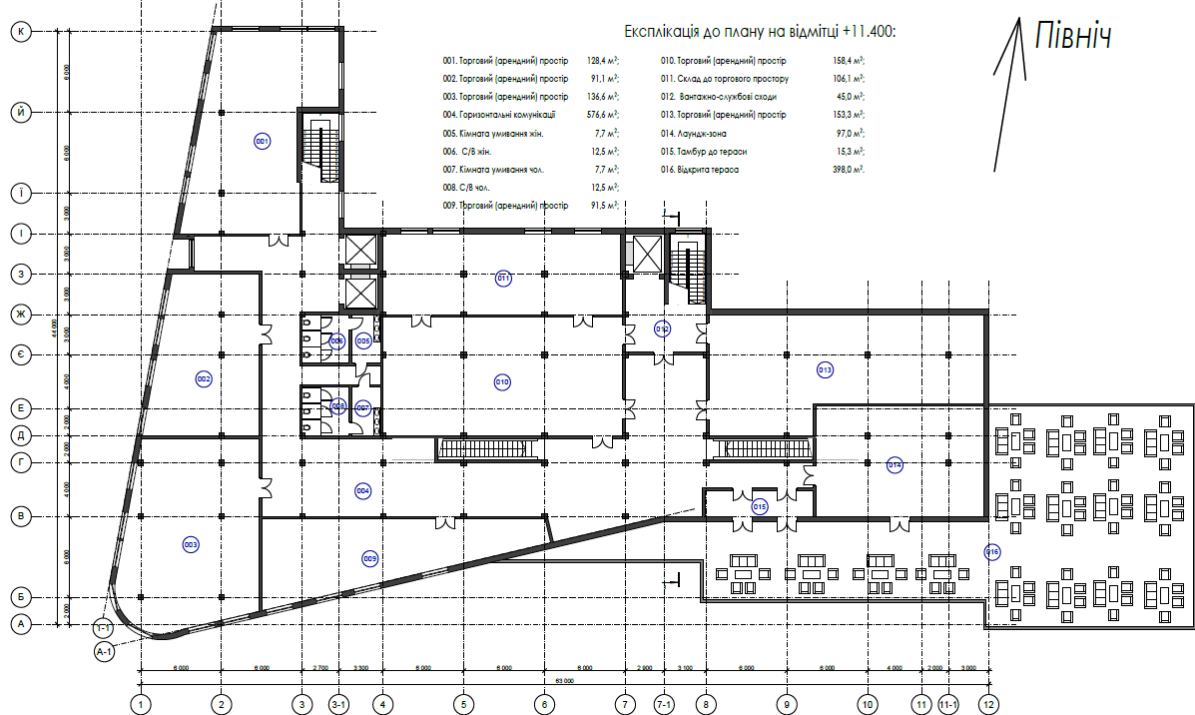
План четвертого поверху нової будівлі – торговельного центру
